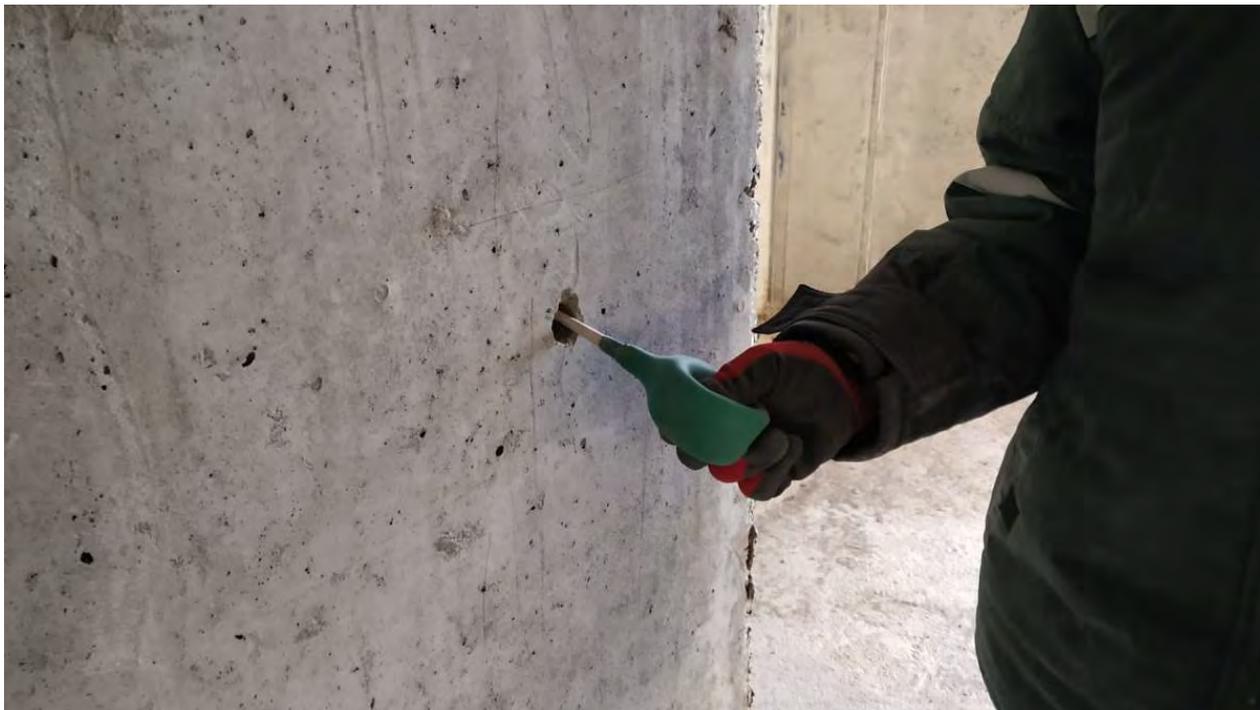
Продувка отверстия от пыли в монолитном железобетонном пилоне в осях 6с2-7с2/Вс2
